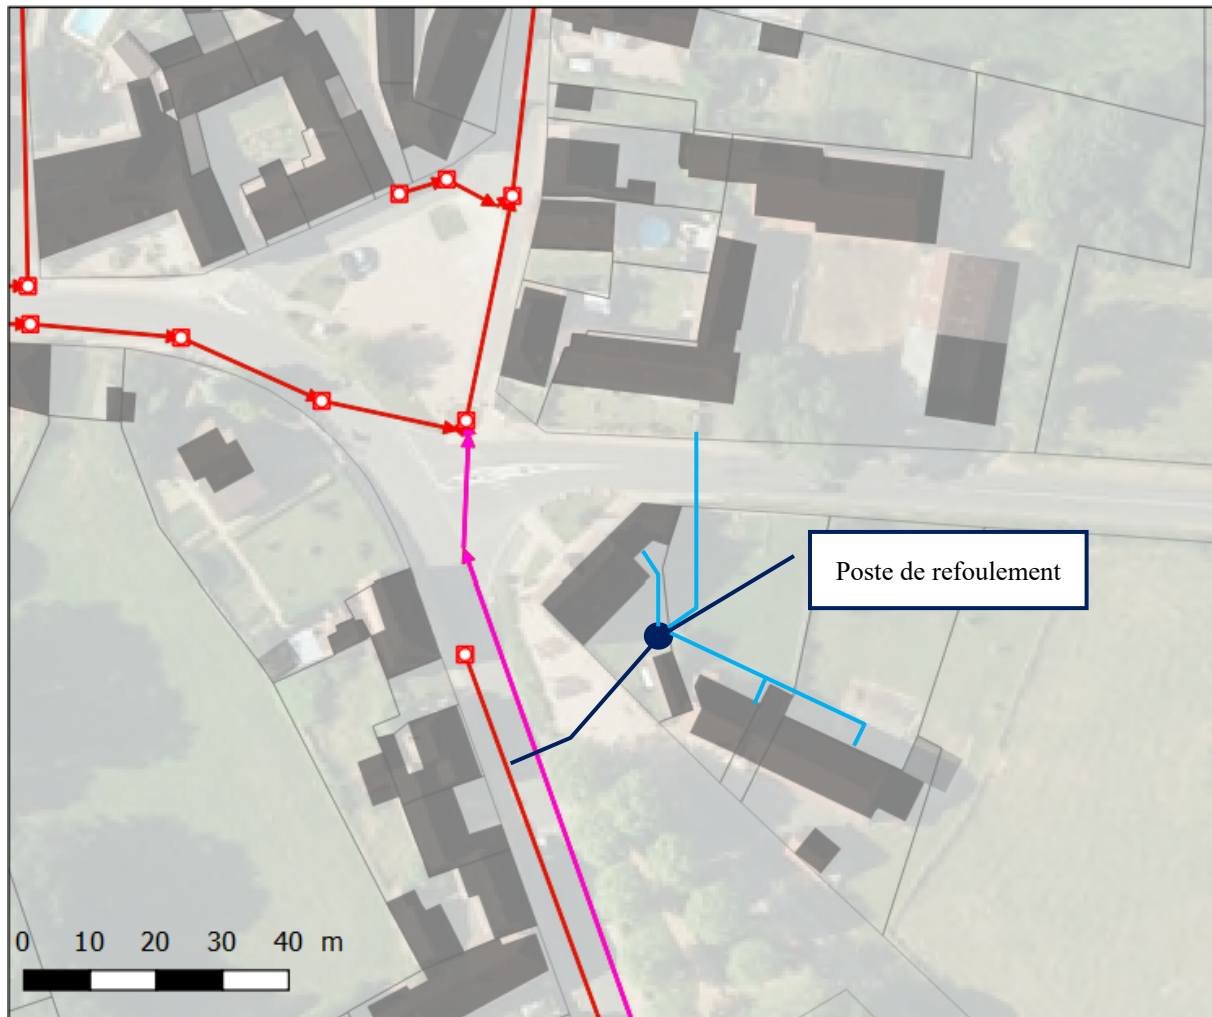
Plan des installations d'assainissement non-collectif – secteur mairie
